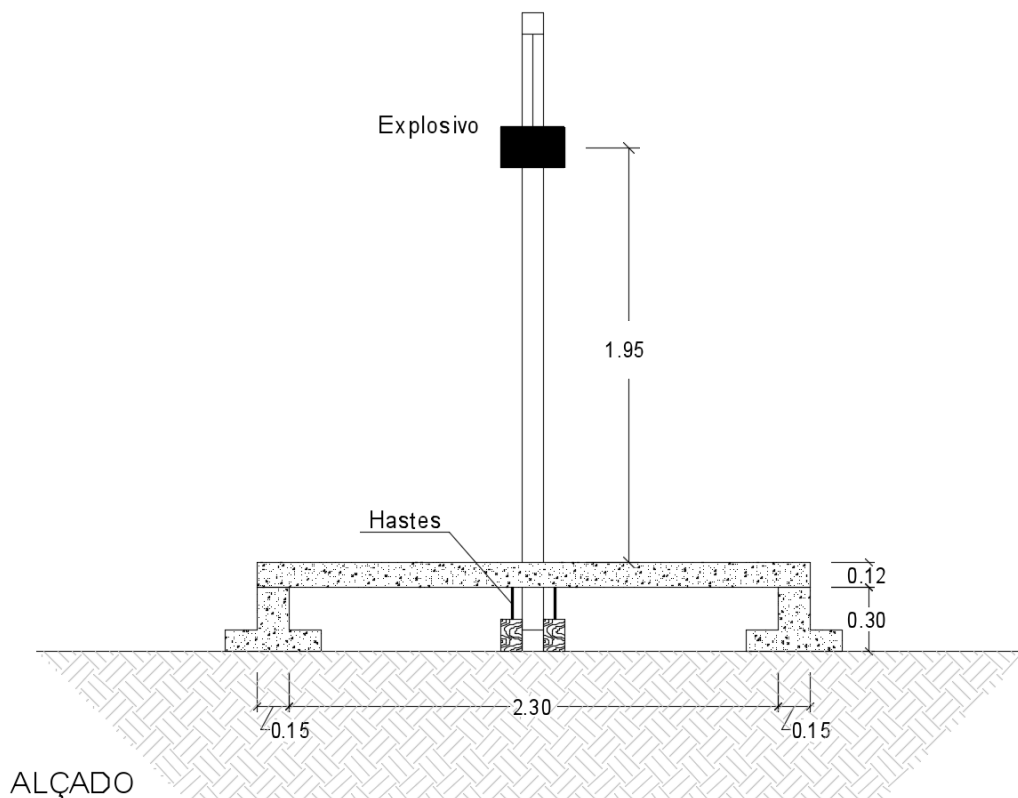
Alçado do esquema de ensaio com localização das hastas metálicas
